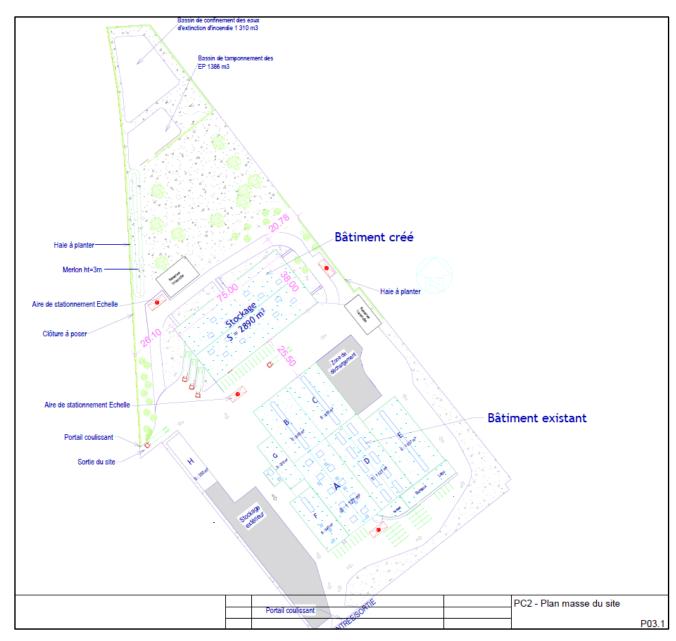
Plan d'ensemble du site (source : sicabconstruction)
